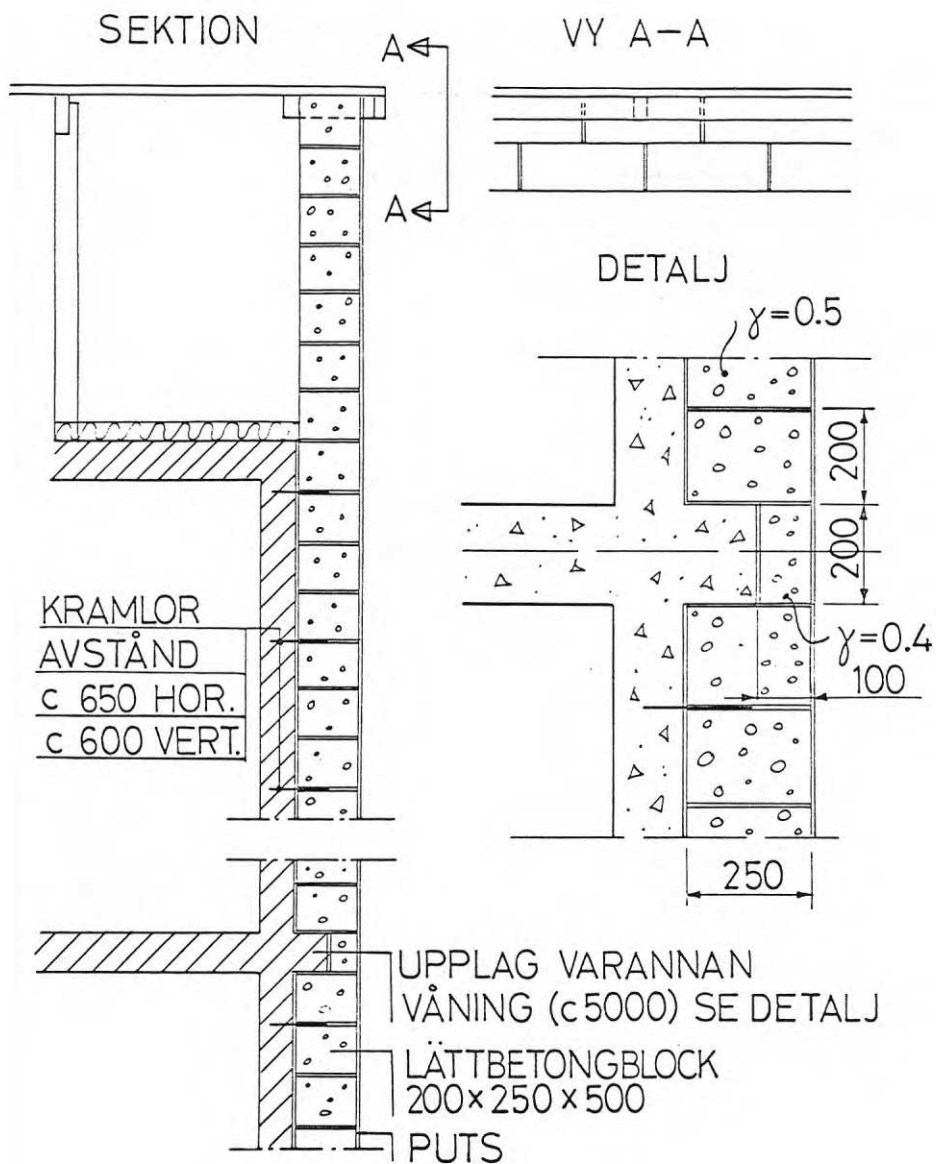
Konstruktionsutformning av den skadade lättbetongskalmuren.
